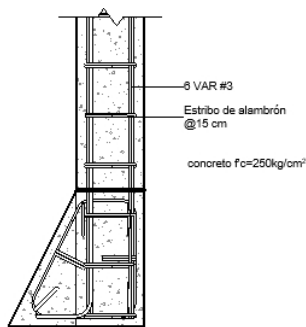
Detalle estructural de la zapata y armado de columna.
